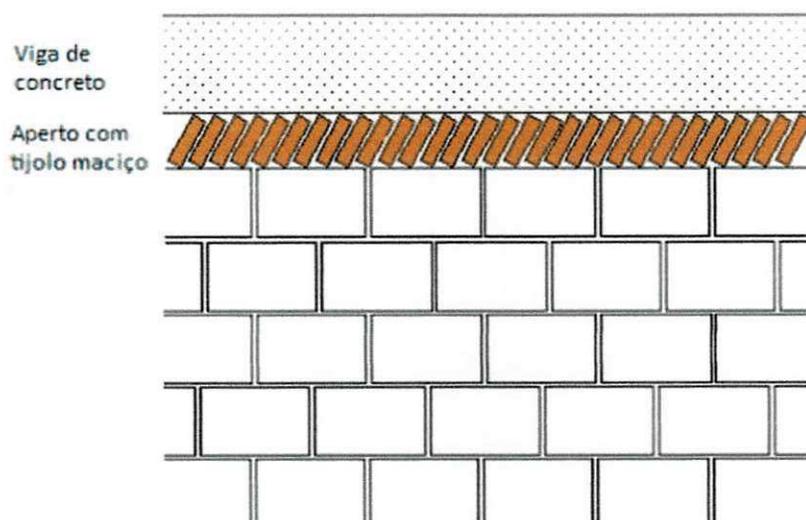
Aperto de alvenaria com tijolo maciço ("encunhamento").
